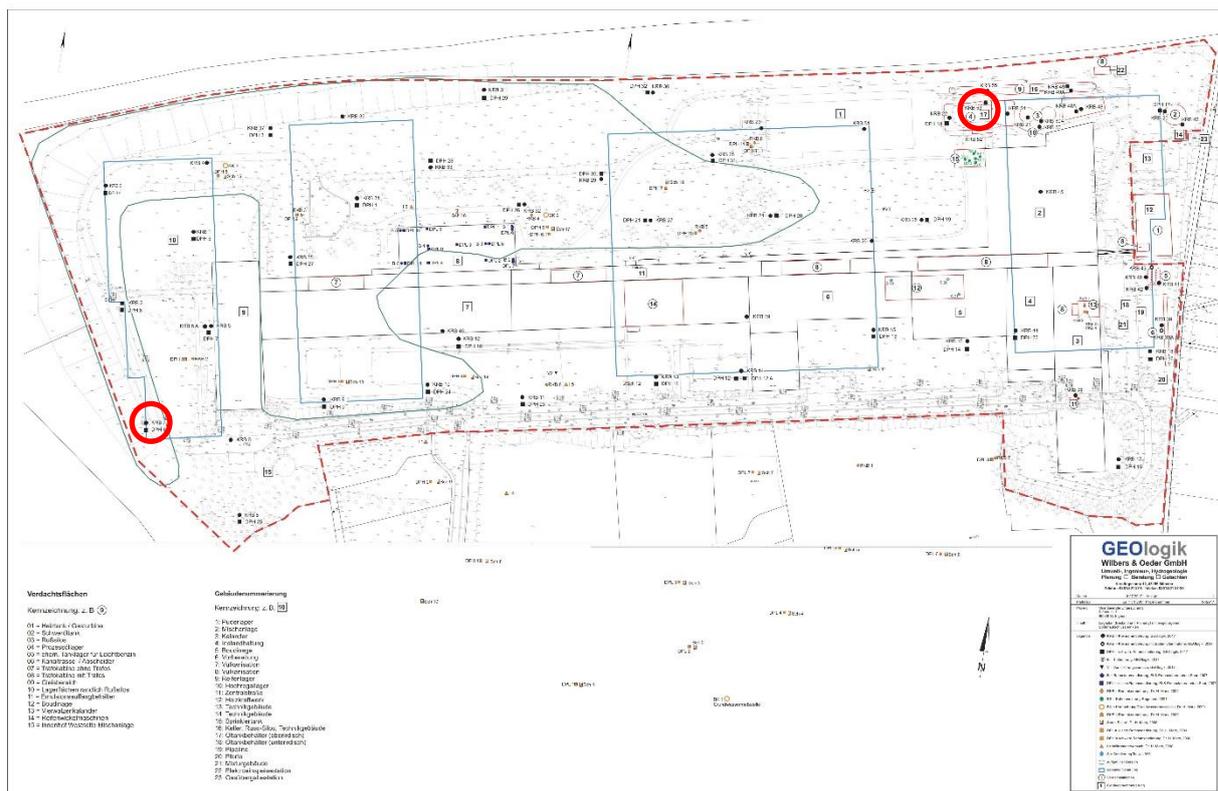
Lageplan mit Kennzeichnung der Teilbereiche mit erhöhten Schadstoffbelastungen (rot)²²
